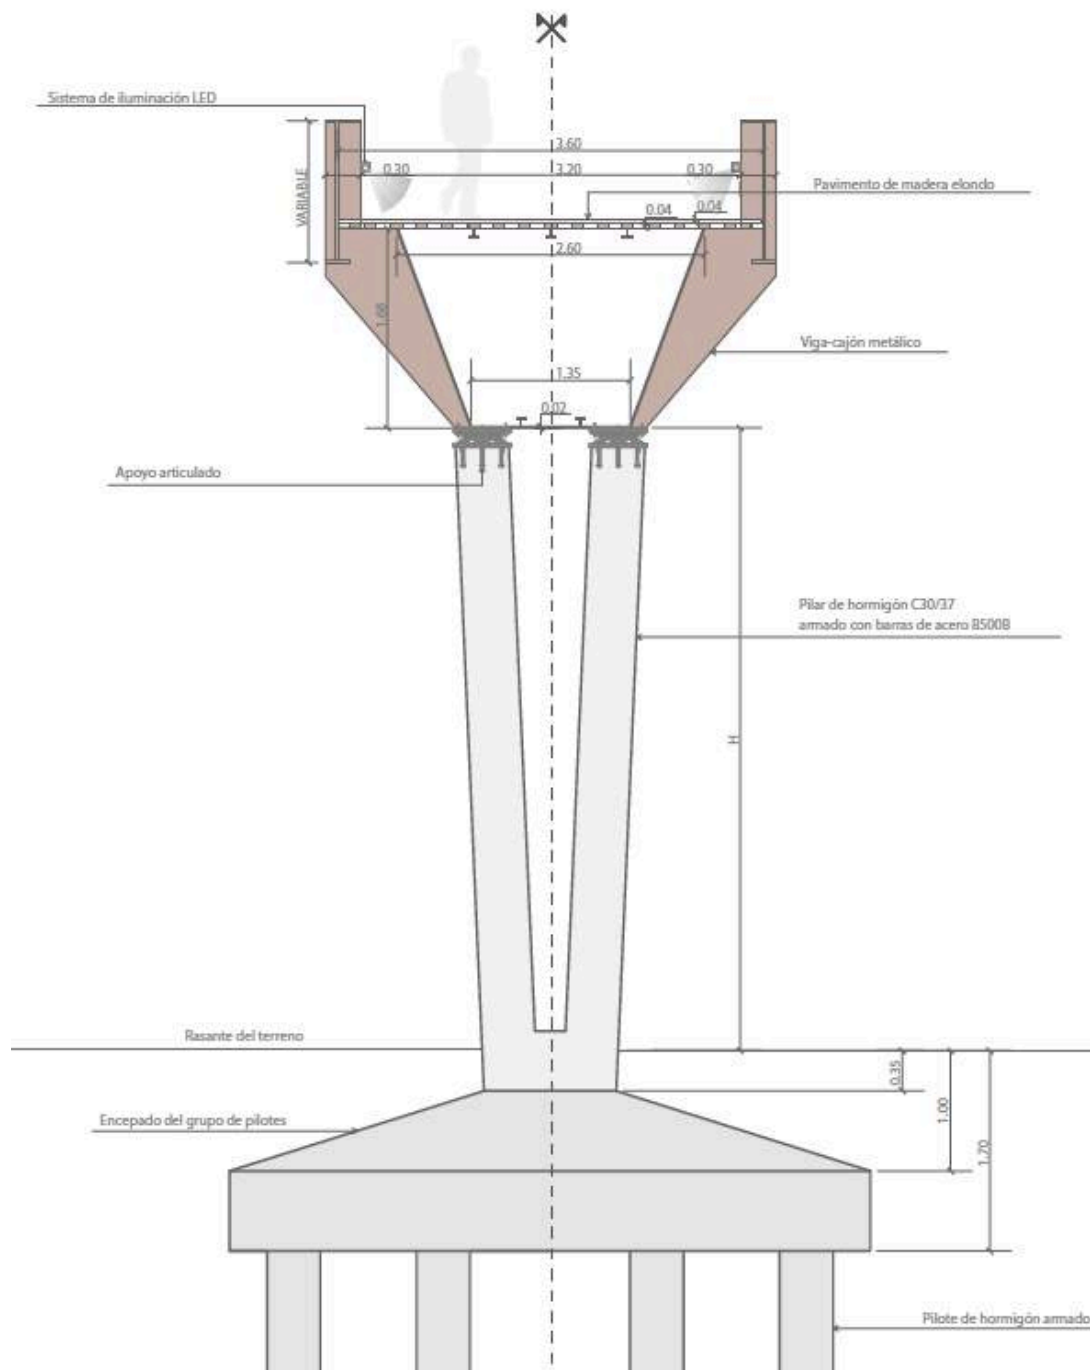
Recorte del plano “Sección tipo de la pasarela junto con los pilares”
